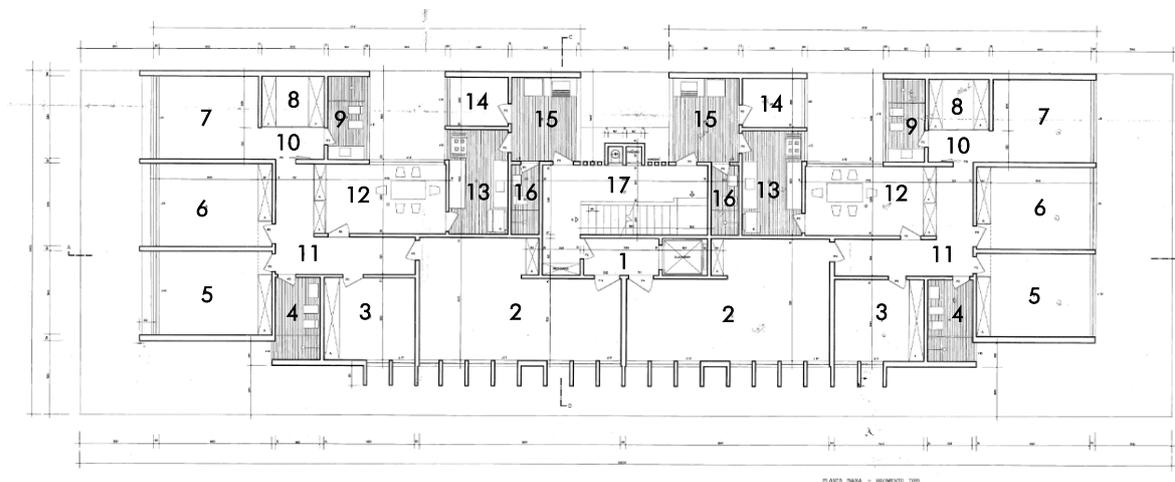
Planta baixa do pavimento tipo, com núcleo central de circulação e um apartamento de cada lado, destacando-se a seqüência de elementos dispostos na fachada longitudinal. Programa: 1. Hall Social; 2. Sala de Estar;
